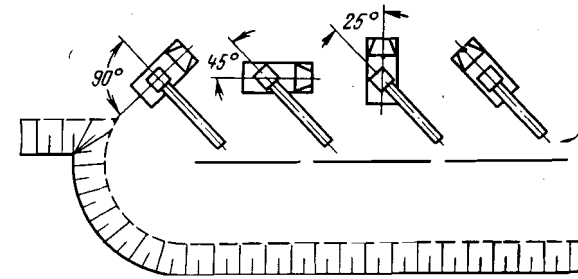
Установка автосамосвала под разными углами к стреле экскаватора
